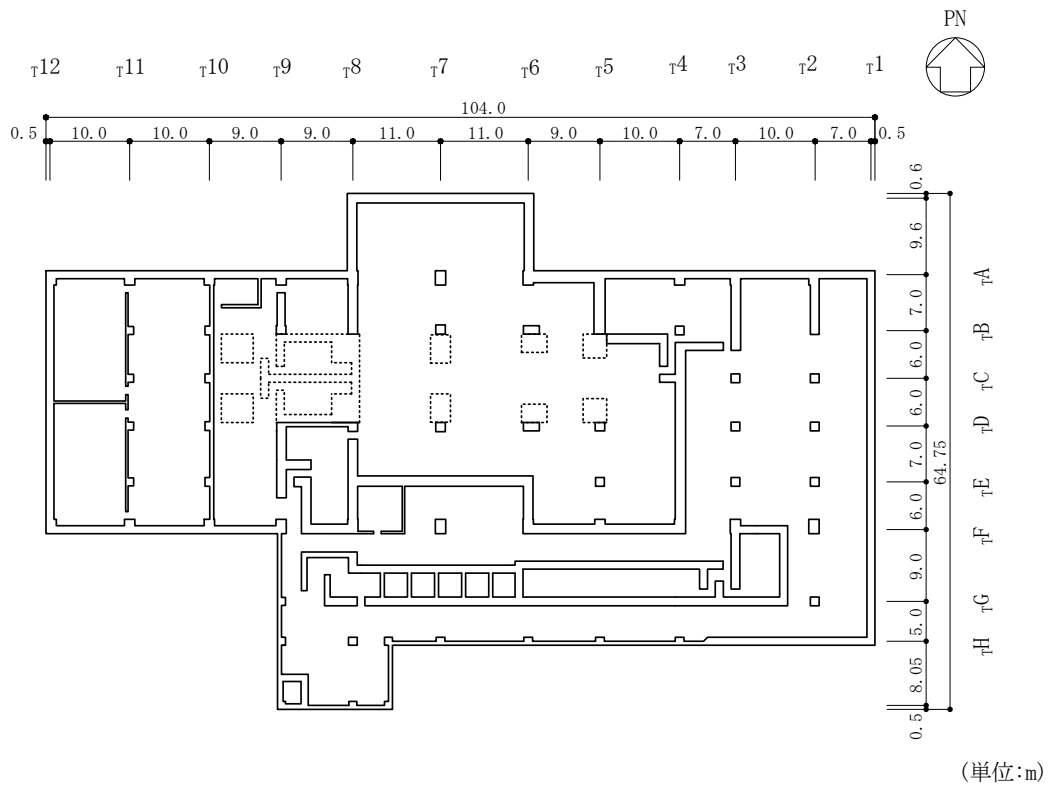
1号機タービン建物の概略平面図 (EL 1.8m*)
